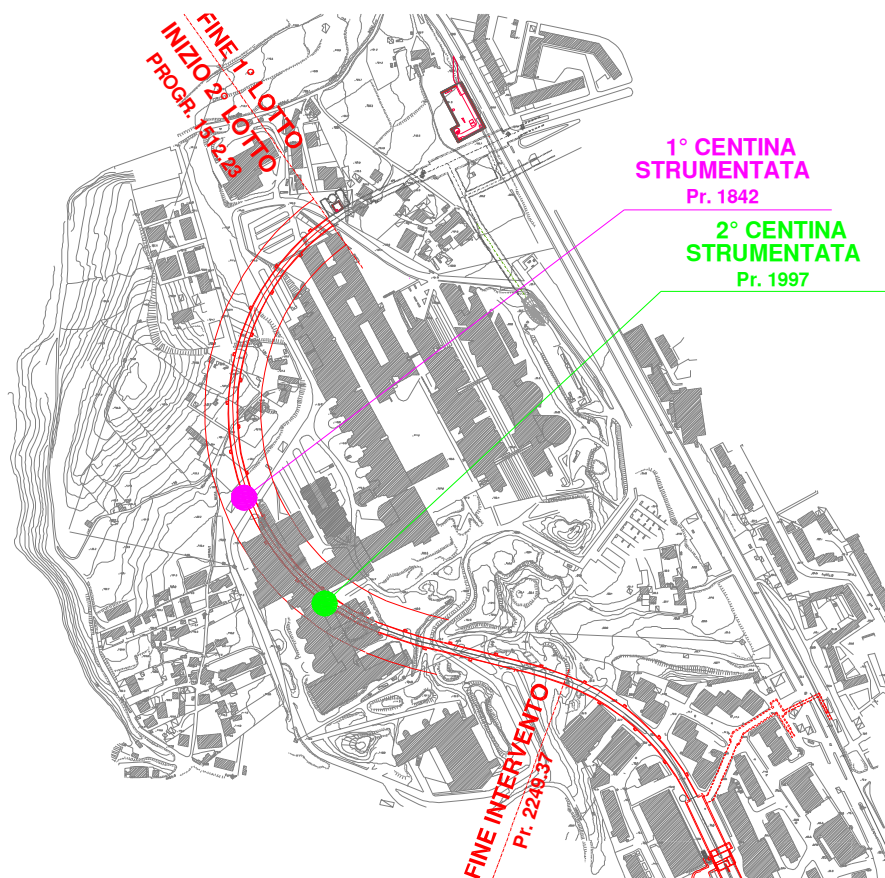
Planimetria del I stralcio/II lotto della linea 7 con indicazione delle sezioni strumentate.
